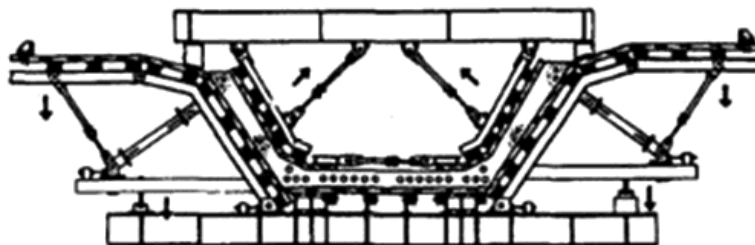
Установка щита внутренней съемной опалубки первой очереди бетонирования
